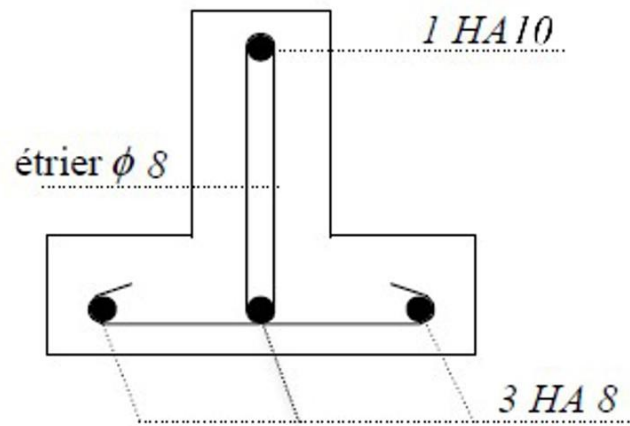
Disposition des armatures dans la poutrelle d'étage terrasse
